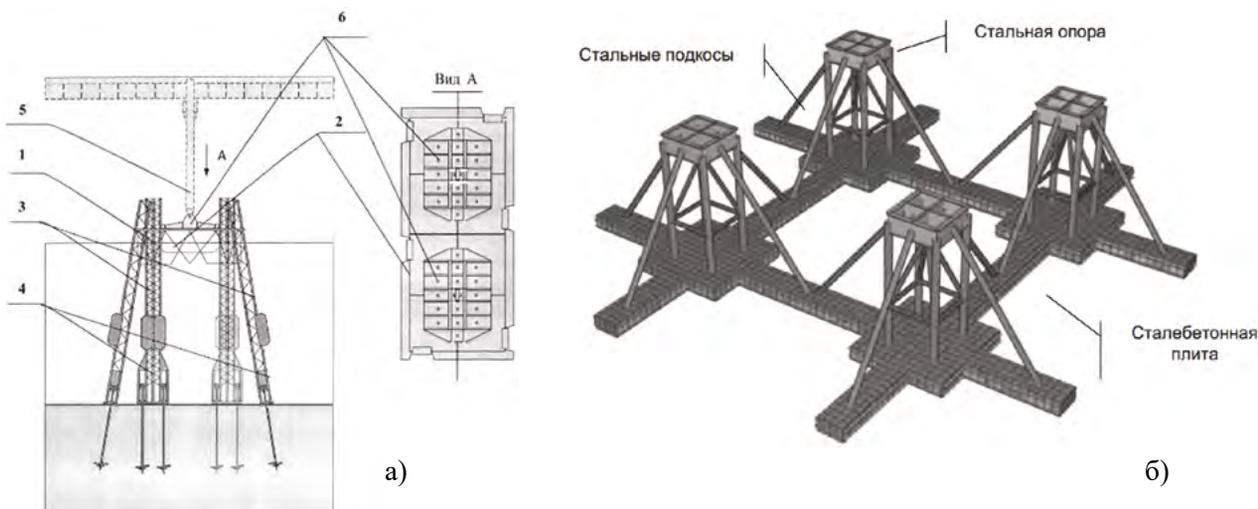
Стальные фундаменты для объектов транспортной отрасли: а) для установки плоских опор транспортной эстакады, где 1 — автономный фундамент, 2 — платформа, 3 — решетчатые фермы, 4 — винтовая свая, 5 — эстакада, 6 — бабки опоры [5]; б) для башни радиорелейной связи [6]
